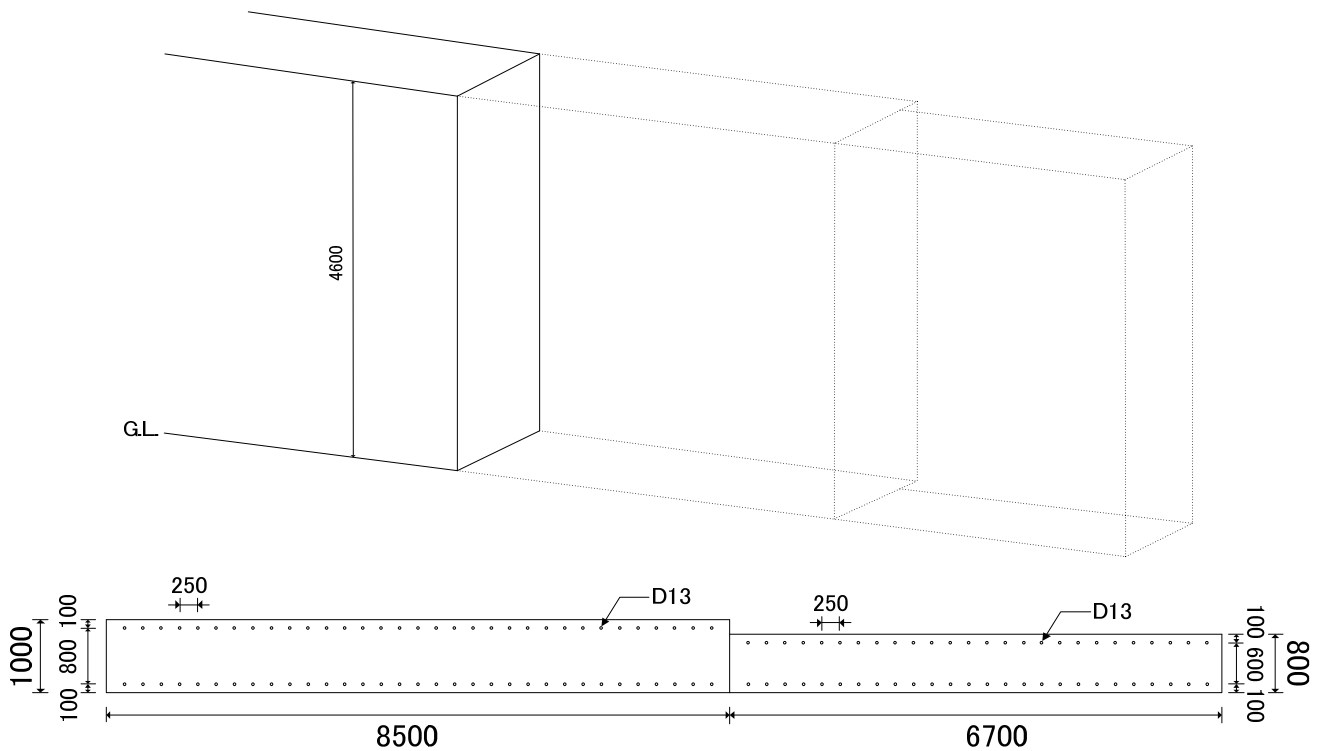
防潮堤の配置図・断面図 (写真 3-11-1-1 参照) (単位 : mm)
